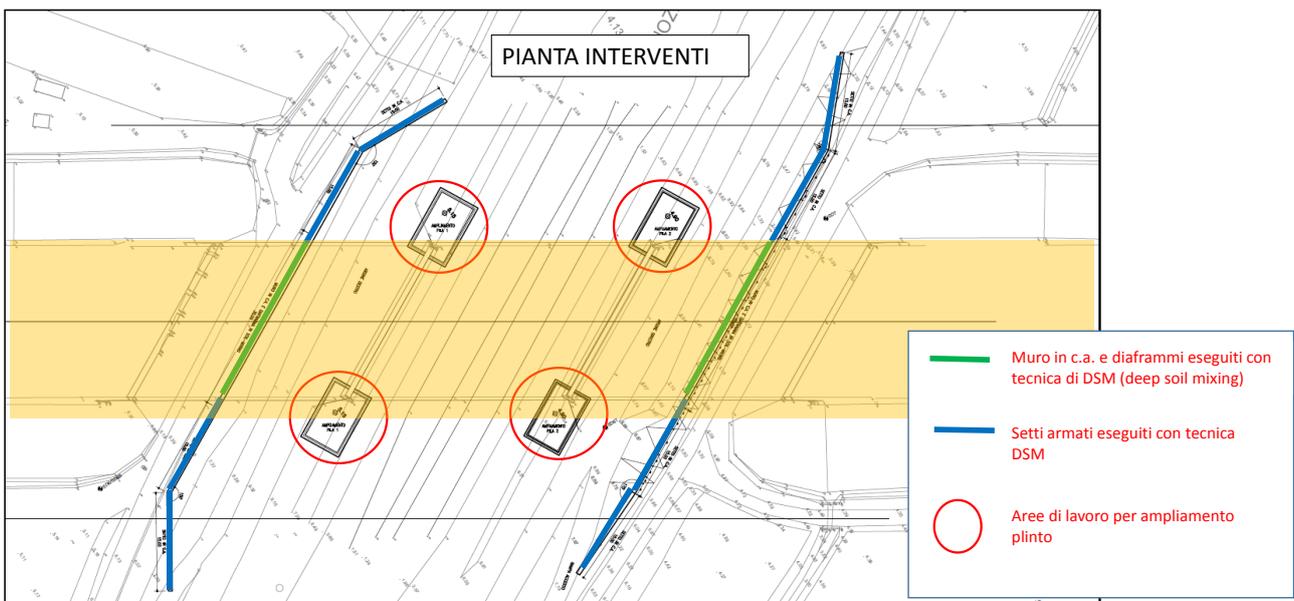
Ponte Canale Vigenzone – Pianta interventi
